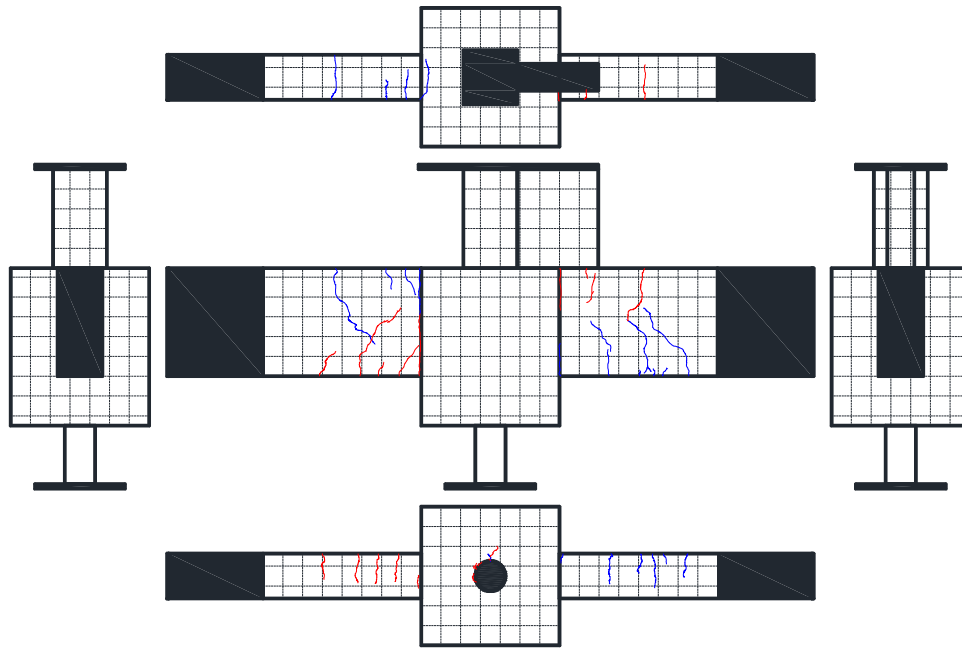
試験体 DR-5 ひび割れ状況 (1Cycle)
